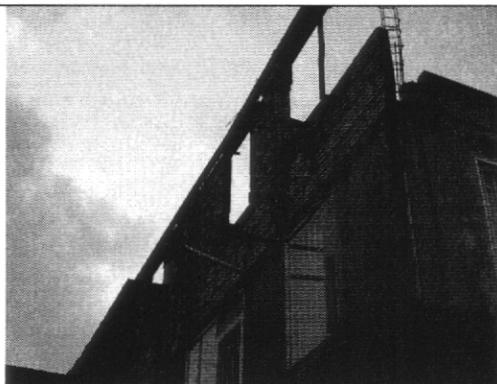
Apartamentos en terceros pisos sin terminar con fachadas sueltas.
